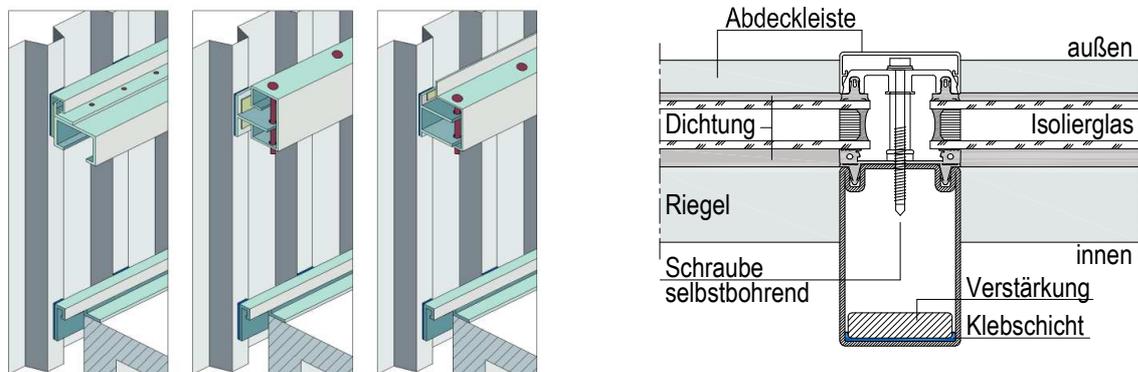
Links: geklebter Fassadenanschluss; rechts: geklebte Fassadenverstärkung
